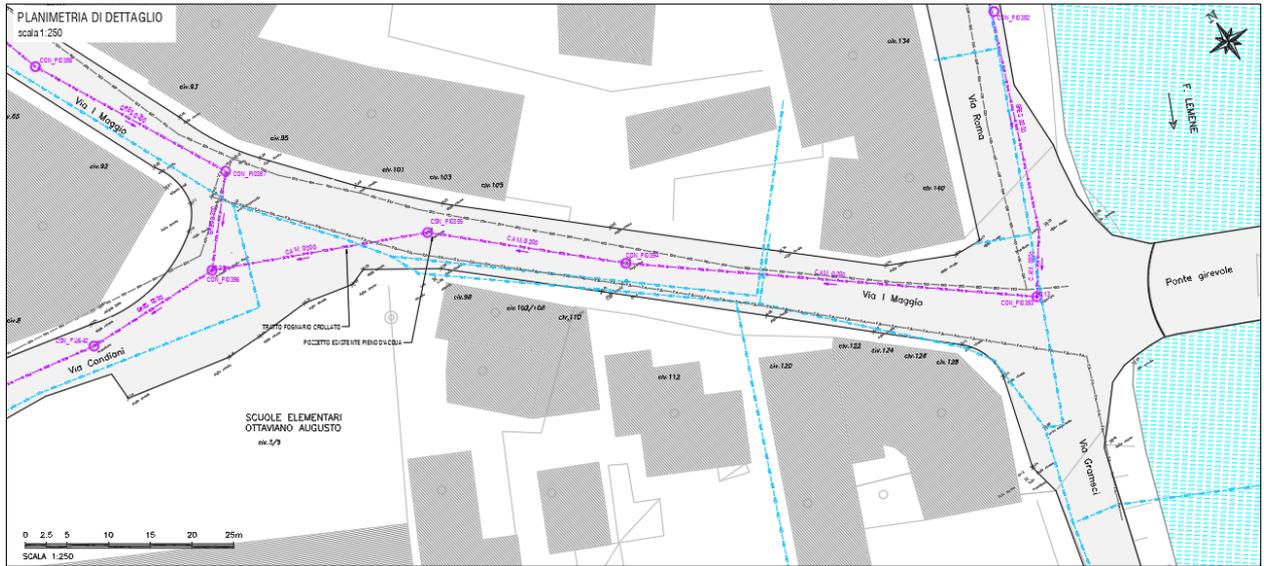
Estratto della planimetria dello stato di fatto e dei sottoservizi
